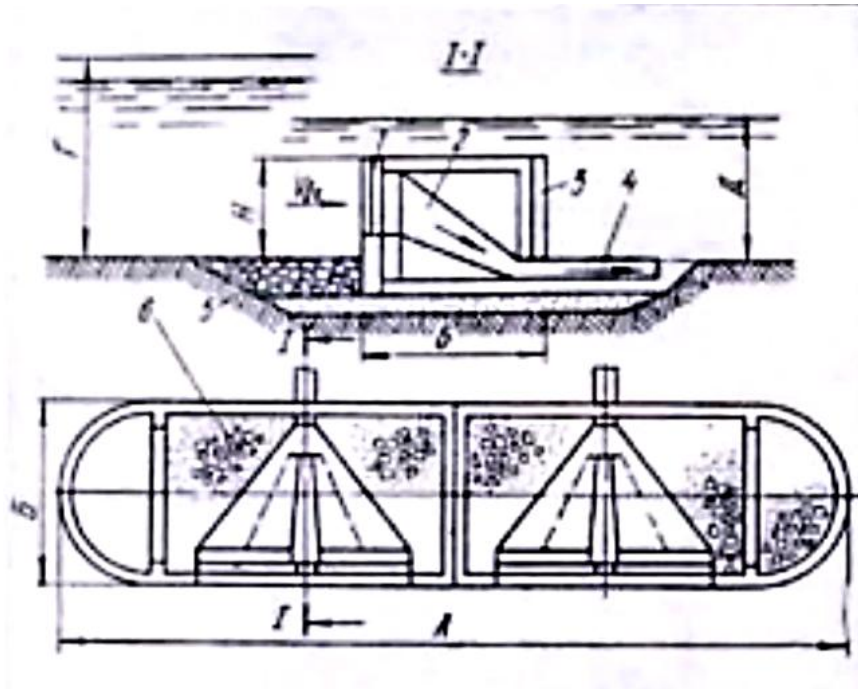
Залізобетонний розтрубний захищений оголовок з боковим прийомом води
